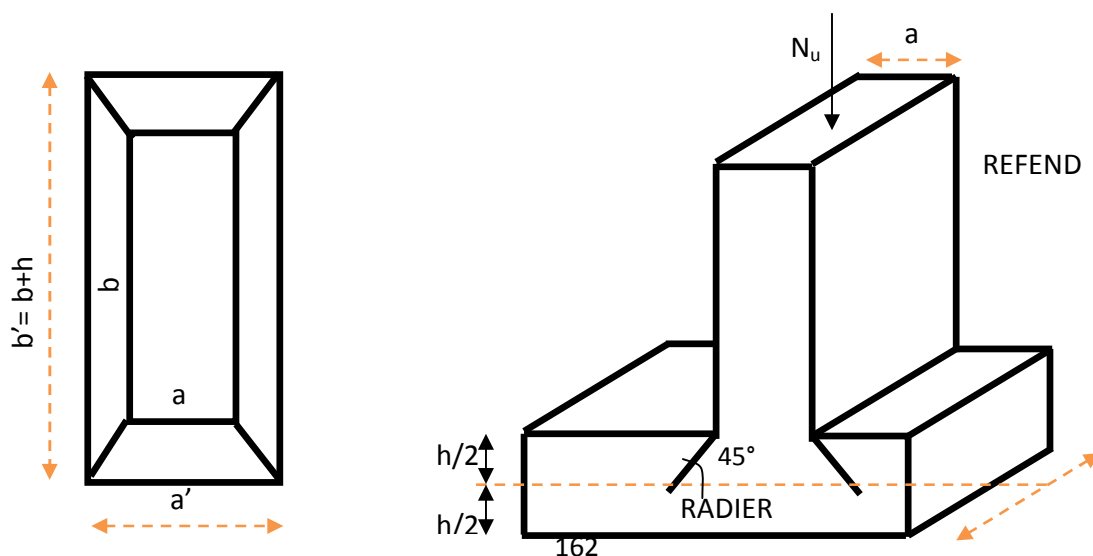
Périmètre utile des voiles et des poteaux.
